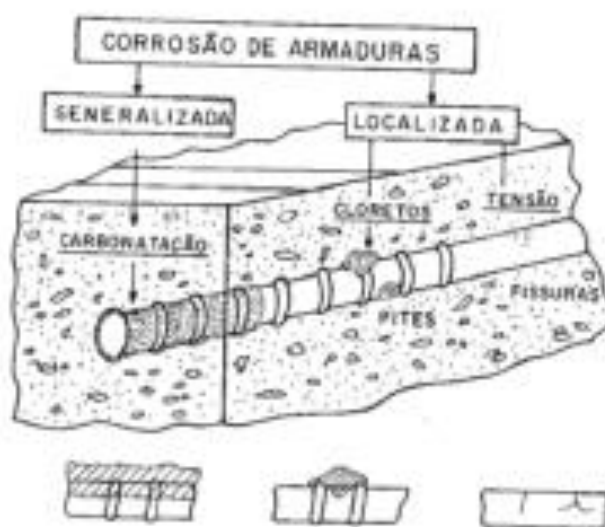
Tipos de corrosão da armadura [25].
